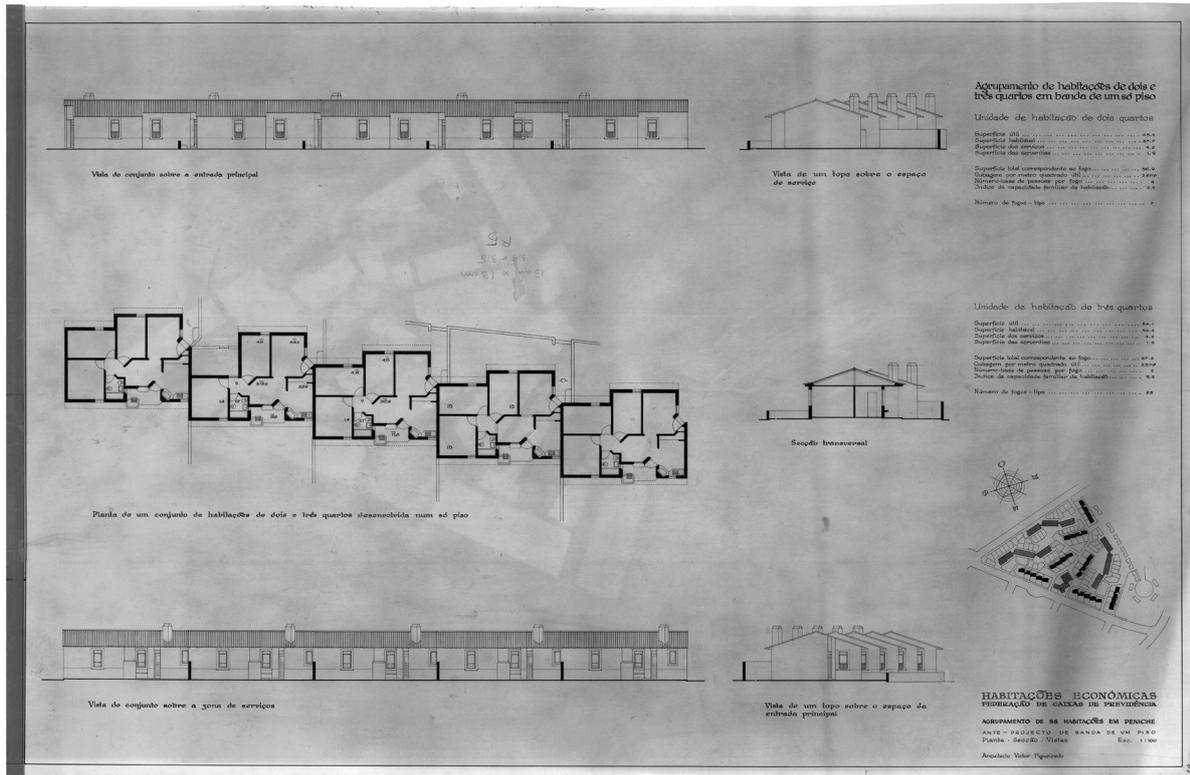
Anteprojeto: banda de 1 piso - planta, secção e vistas
